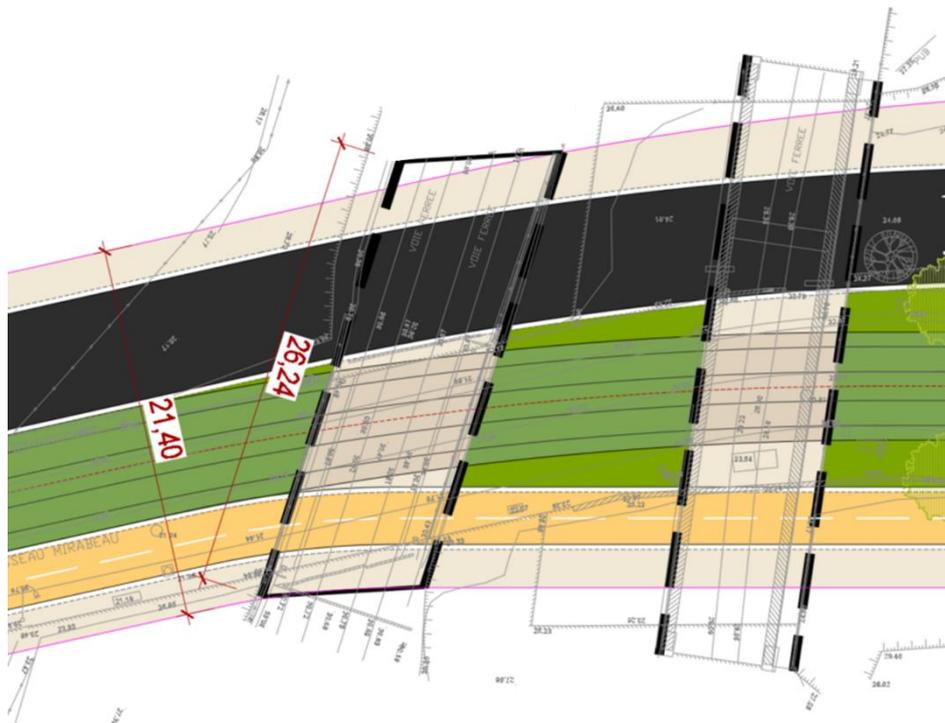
Plan d'insertion faisant figurer le trait de coupe dans l'axe de l'OA
